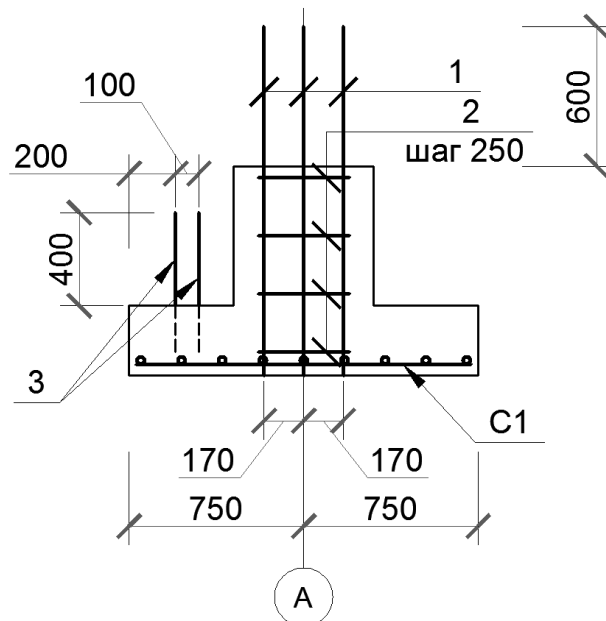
Армирование монолитного фундамента: 1 – выпуски рабочей арматуры колонны $\phi 20$ А-III(А400), 2 – поперечная конструктивная арматура $\phi 8$ А-III, 3 – выпуски арматуры монолитной стены подвала $\phi 12$ А-III (А400).
